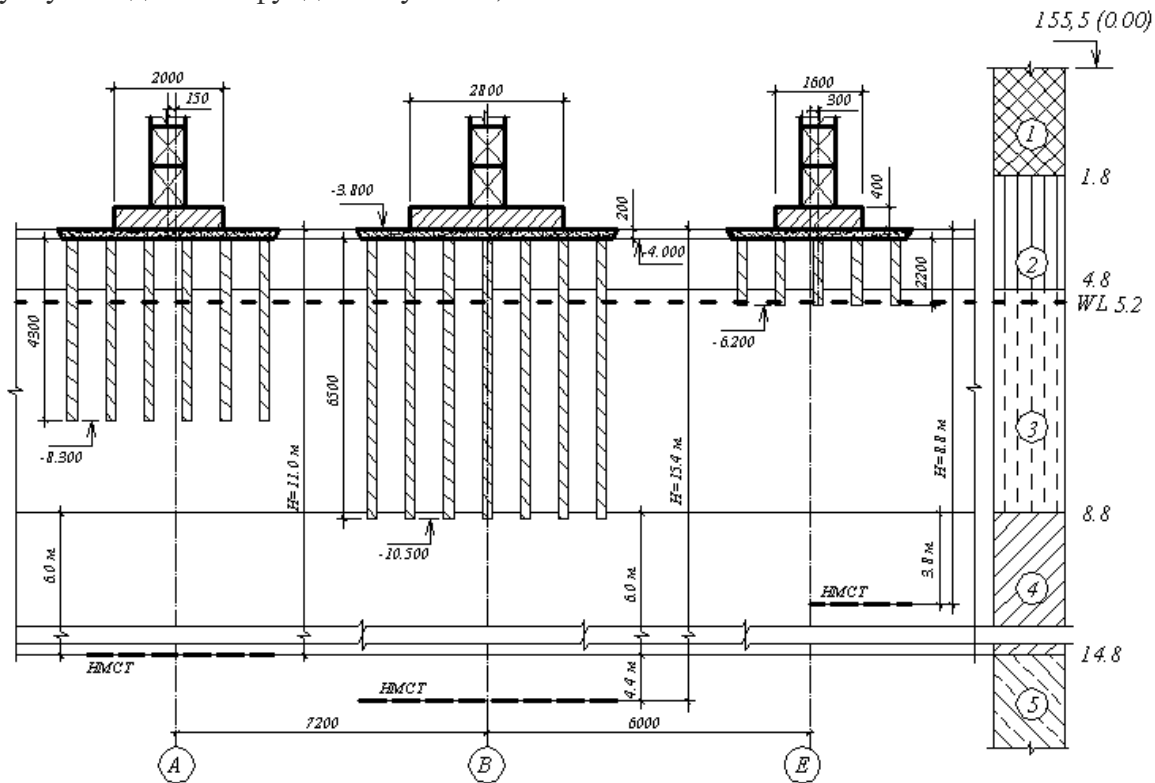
Розрахункові схеми для розрахунку осідань основи житлової будівлі.
